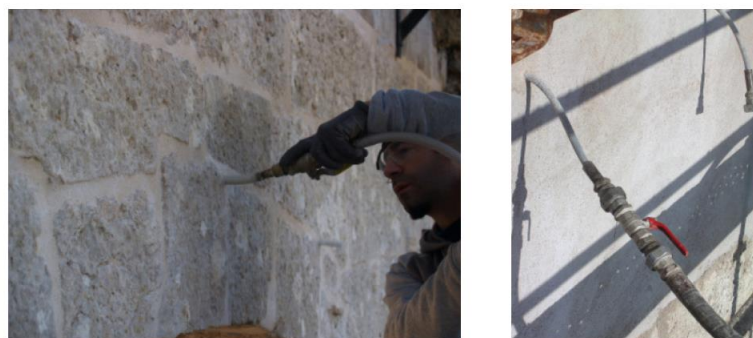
Técnica de consolidação estrutural: injecção de *grout* (Brás, 2011)
